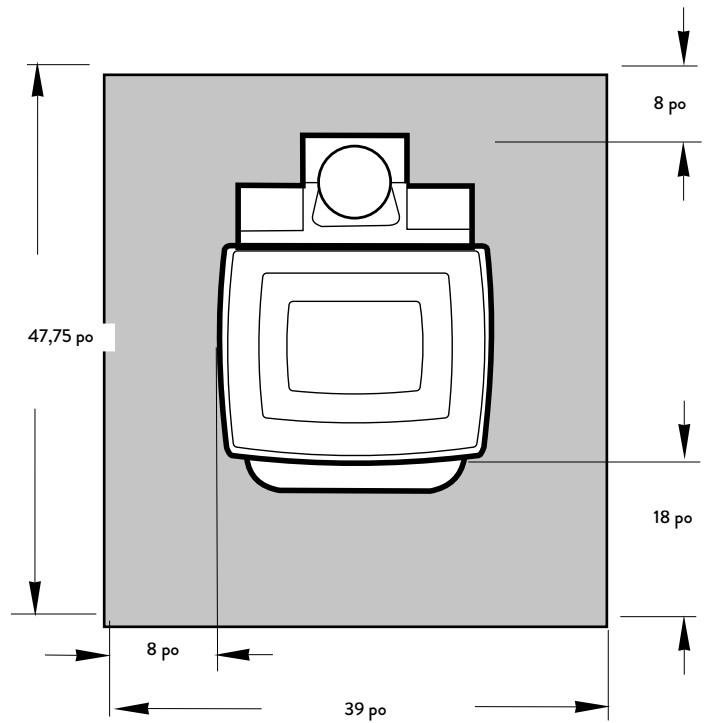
Dimensions minimales de la protection du sol, CAN. Sortie vers le haut.
